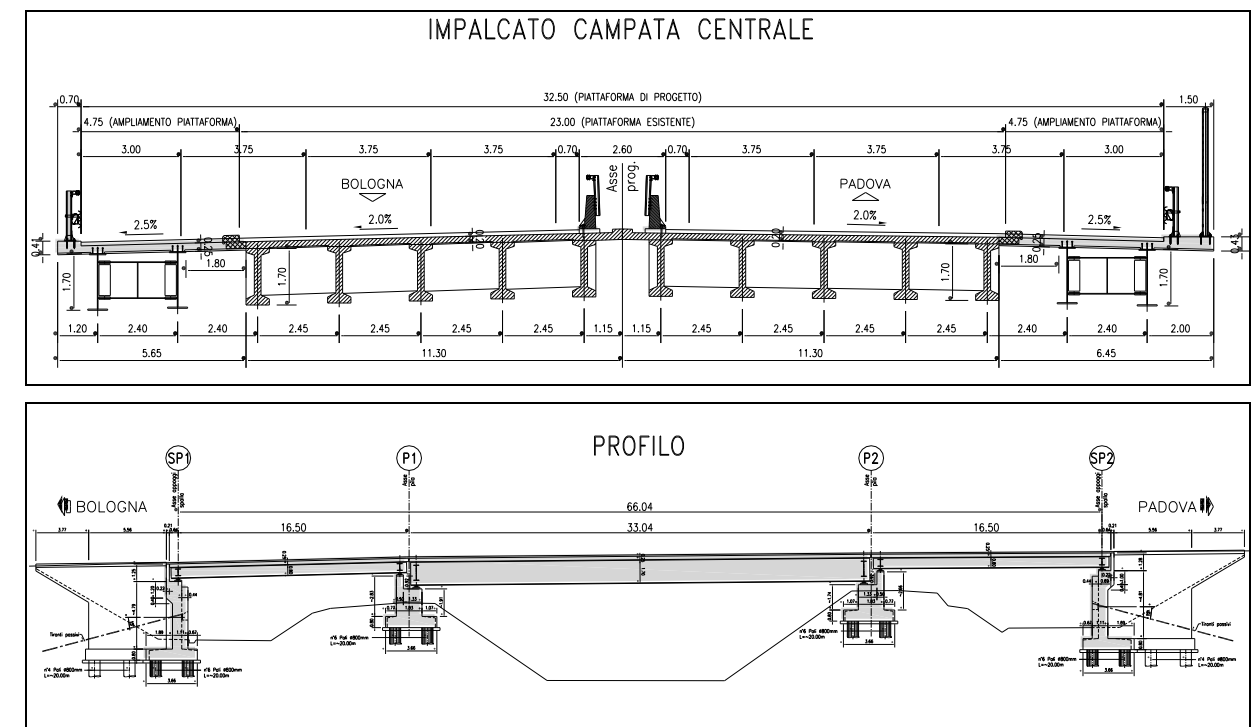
Sezione dell'impalcato e profilo del ponte sul canale Canaletta
